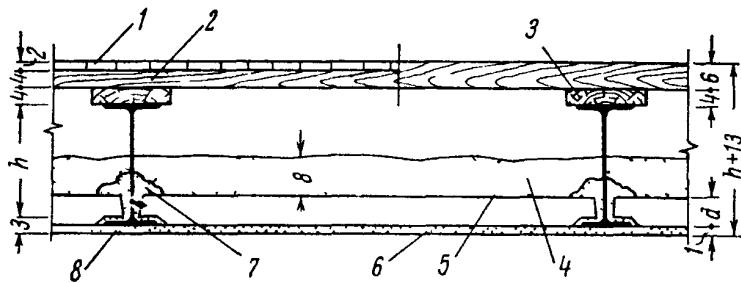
Конструкция междуэтажного перекрытия из стальных двутавровых балок с заполнением плоскими железобетонными плитами
